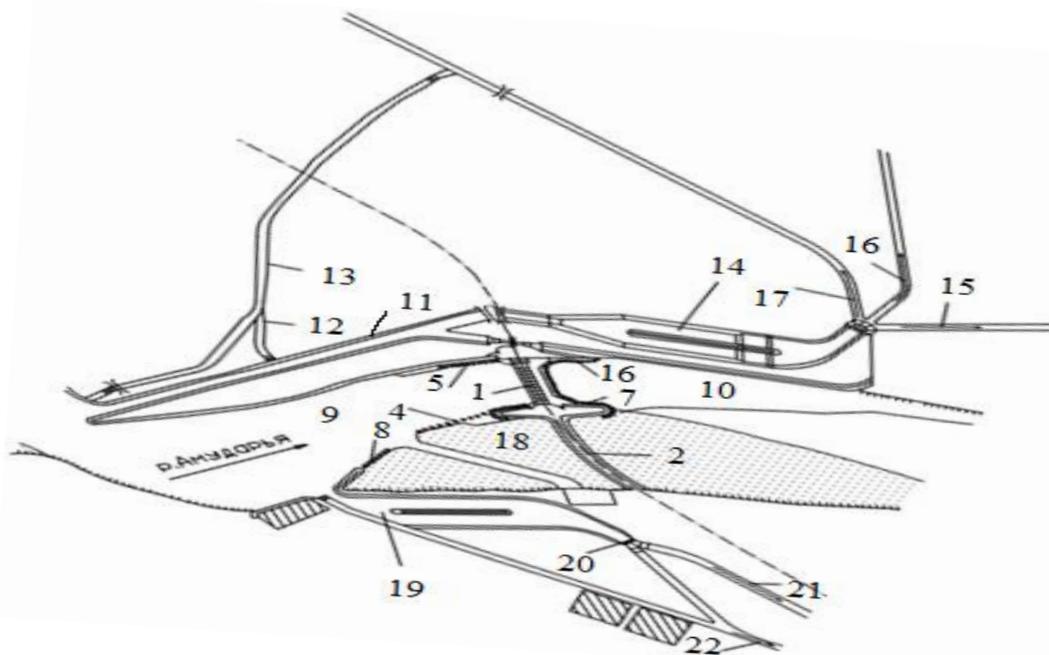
Схематический план Тахиаташского гидроузла: 1-щитовая плотина с рыбопропускными пролетами; 2-земляная плотина; 3-проран; 4-8-струенаправляющие дамбы; 9-подводящее русло; 10-отводящее русло; 11-объединенный канал; 12-водовыпуск для водоснабжения ГРЭС; 13-канал подключения ГРЭС; 14-левобережный отстойник; 15-канал Параллельный; 16-канал Суенли; 17-канал Советяб (не подключен); 18-затон; 19-правобережный отстойник; 20- правобережный вододелитель двойник; 21-канал Рисовый; 22-канал Кызкеткен.
